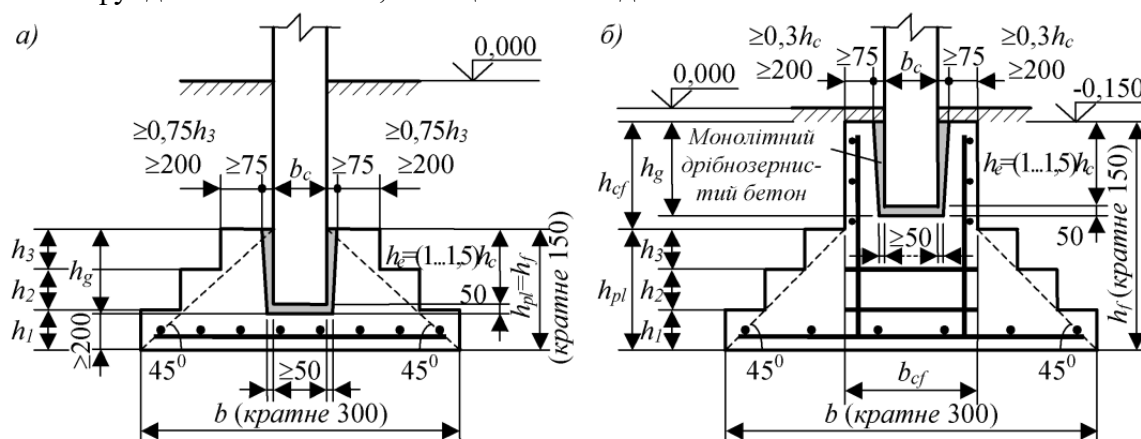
Стовпчасті монолітні залізобетонні фундаменти стаканного типу під збірну залізобетонну колону: а – фундамент, що складаються лише з плитної частини; б – фундамент, що вміщає плитну частину і розвинений підколонник; b_c і h_c – розміри поперечного перерізу колони; h_{cf} і b_{cf} – відповідно висота та ширина підколонника; h_{pl} – висота плитної (конструктивної) частини; h_g – висота стаканної частини; h_e – величина замурування колони у фундамент
